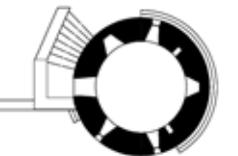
Grundriss Brabant/Müller/Sohar 2010. M 1:400.
